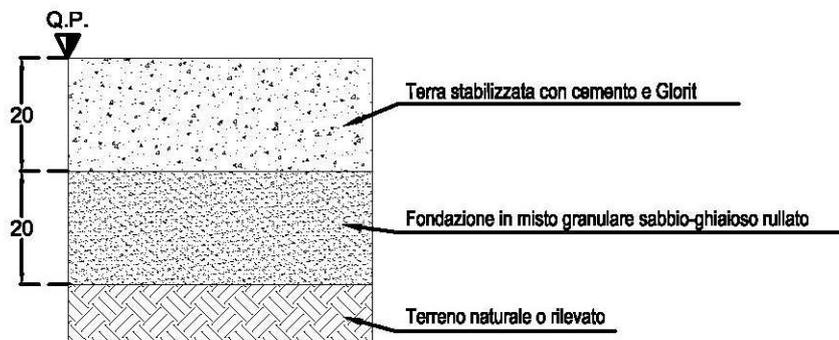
pacchetto di pavimentazione previsto per la strada bianca di accesso alla stazione elettrica di Lesegno
